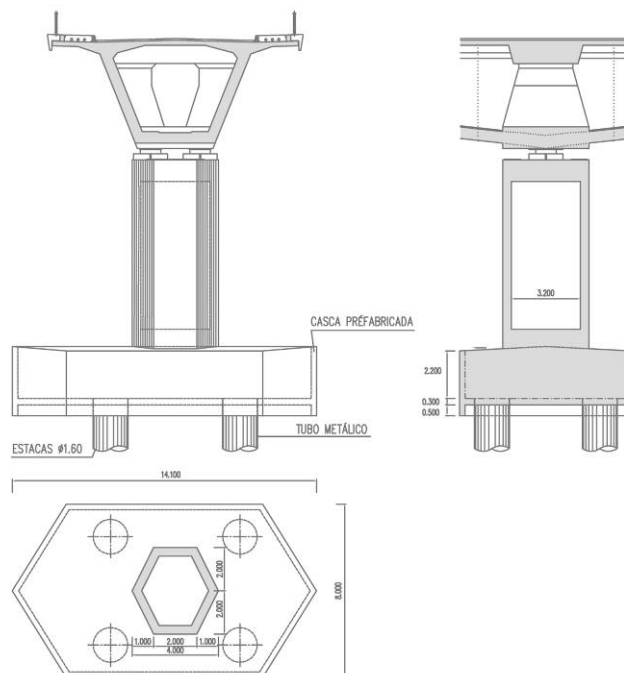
Pilares centrais – Alçado de frente, Cortes longitudinal e horizontal
